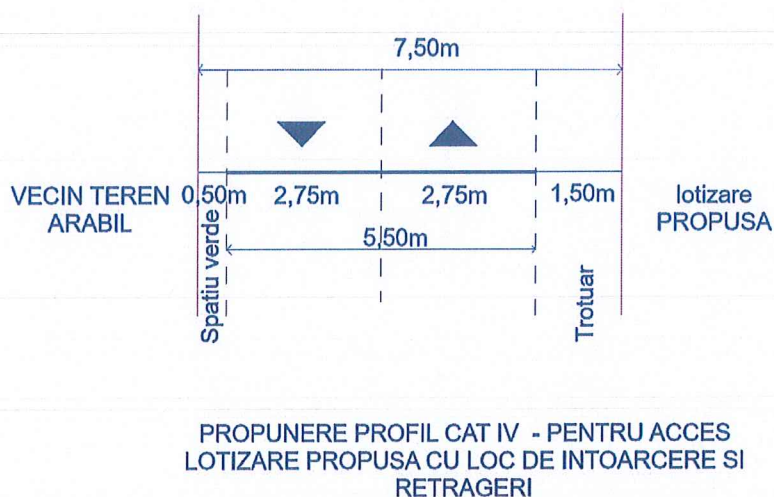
Propunere profil stradal pentru acces lotizarea propusa
